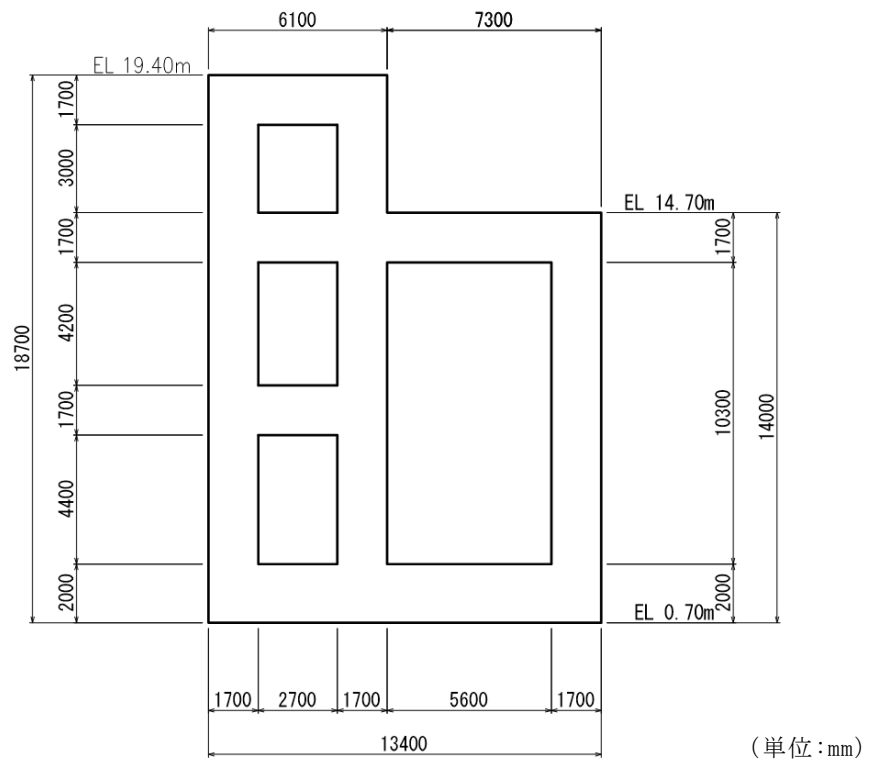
(1) 第 1 ベントフィルタ格納槽 断面図 (A-A 断面)
